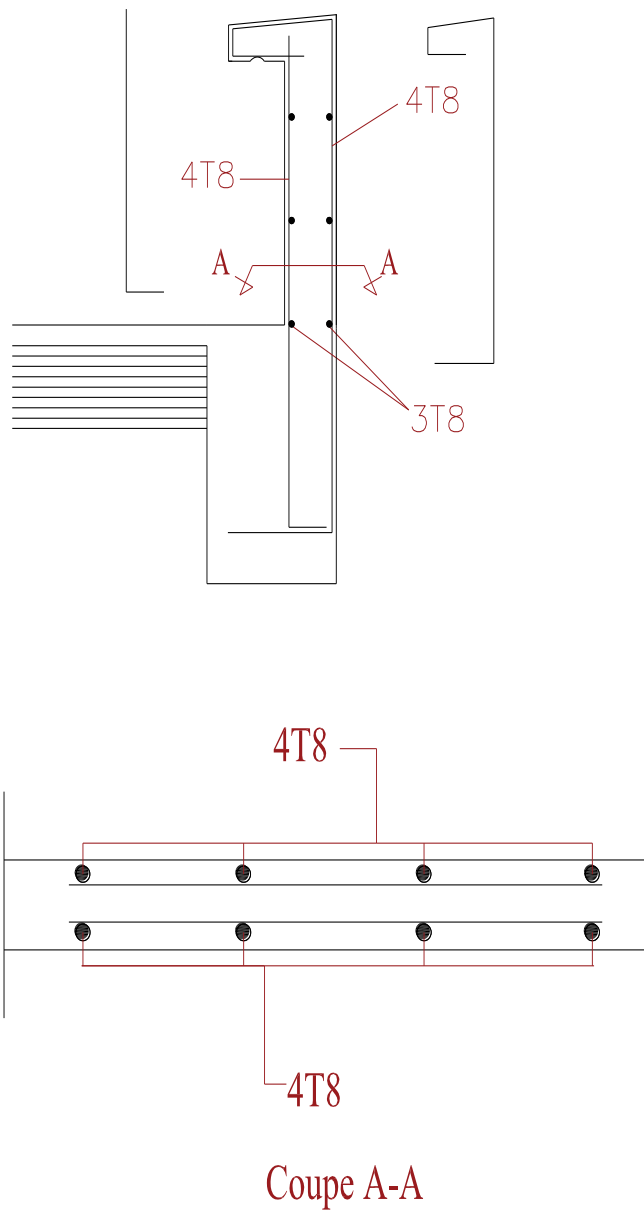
Ferrailage l'acrotère terrasse inaccessible
